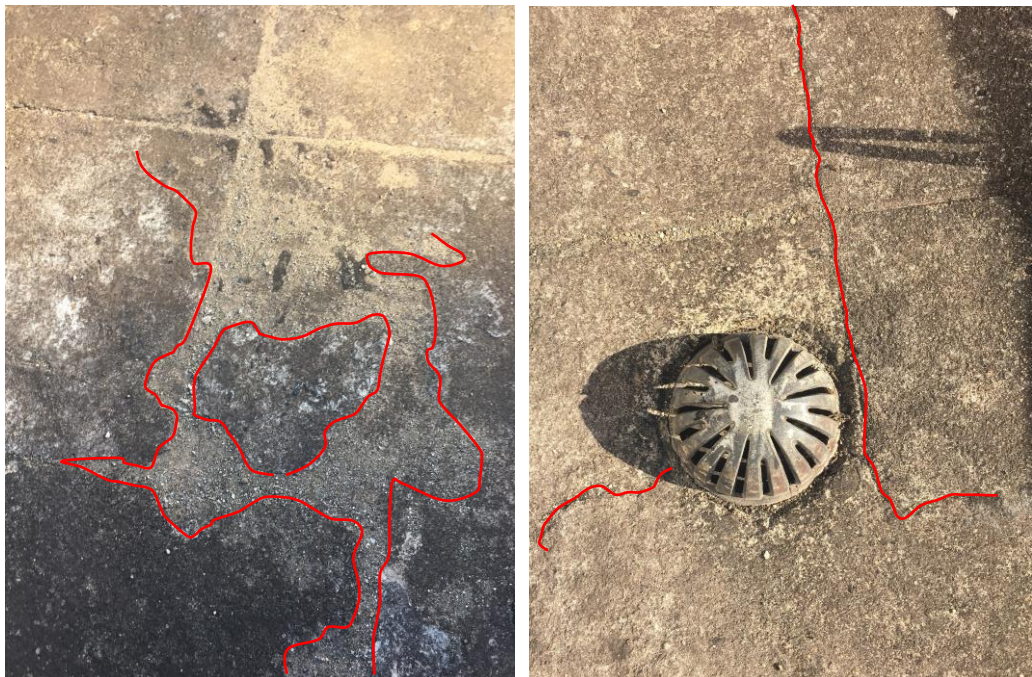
e Figura 54 – Desagregação do concreto e fissurações na proteção mecânica (Autor, 2019).
